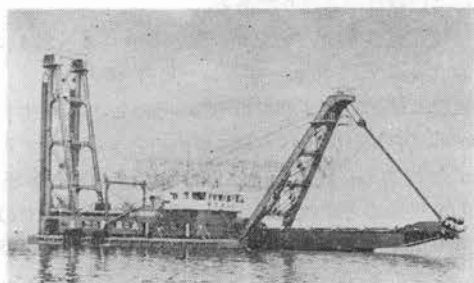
1,200 PS 電動ポンプ浚渫船 '第2朝日丸'
